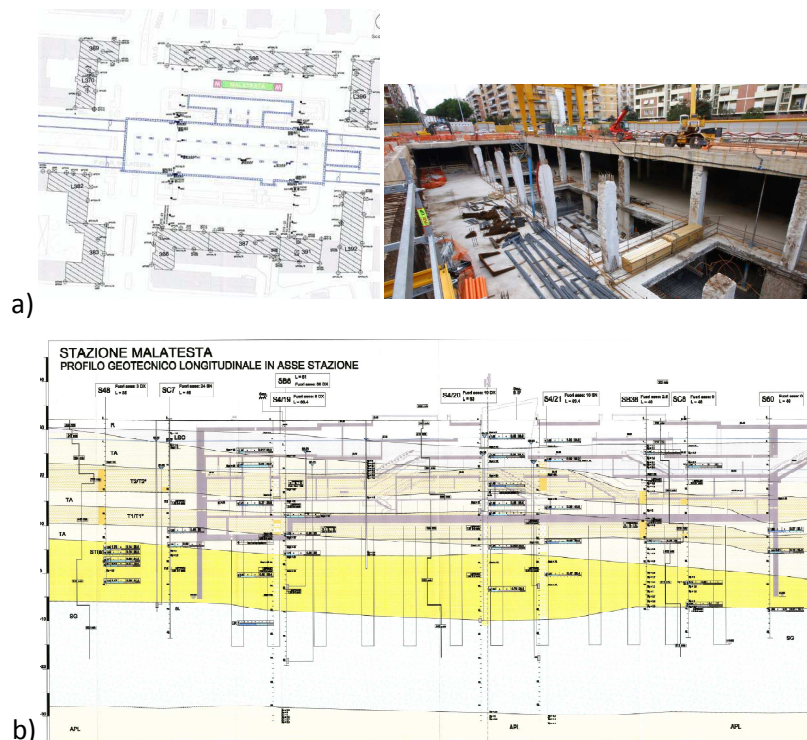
Stazione Malatesta: a) Planimetria e veduta di insieme b) Sezione geotecnica longitudinale
